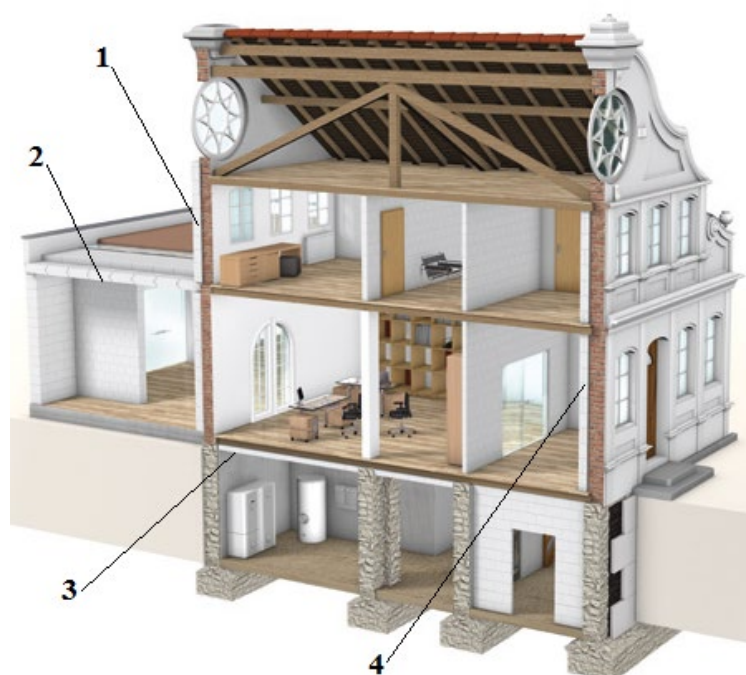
Системы изоляции: 1 — фасадная изоляция; 2 — кровельная изоляция; 3 — изоляция перекрытий; 4 — внутренняя изоляция здания
